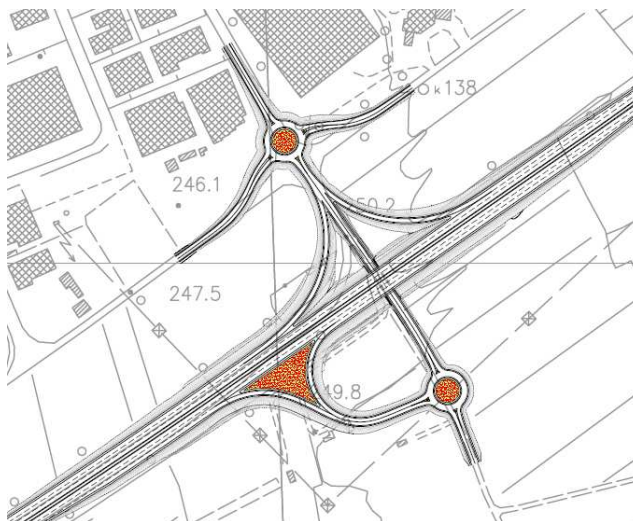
Stralcio planimetrico dello svincolo "San Zeno"
